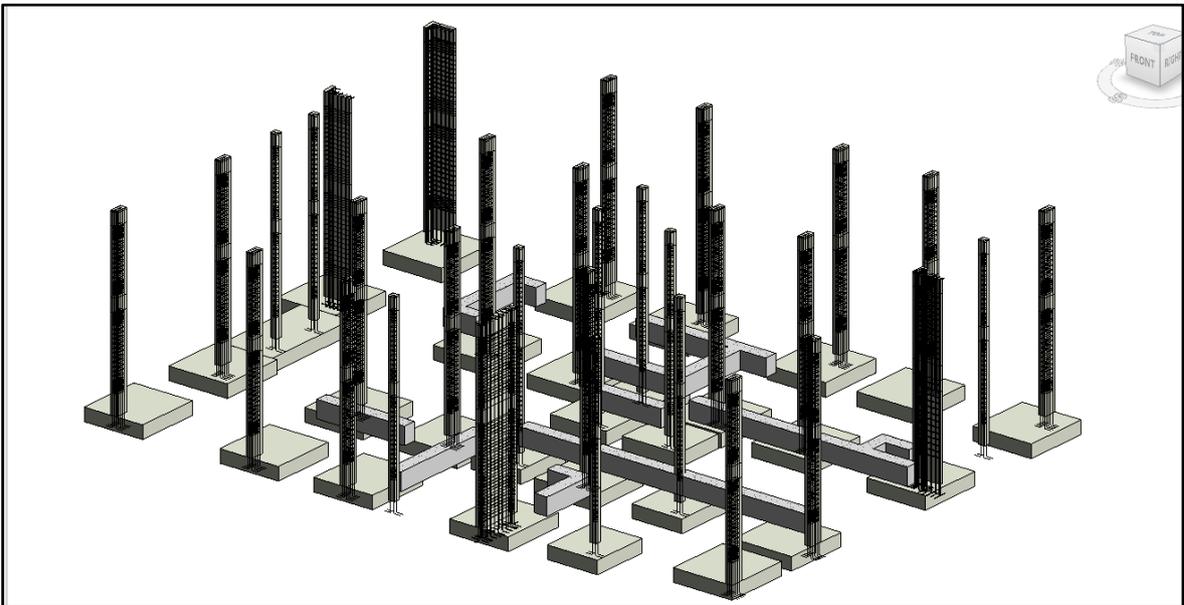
Modelado de Acero de Refuerzo en Vigas de Cimentación
